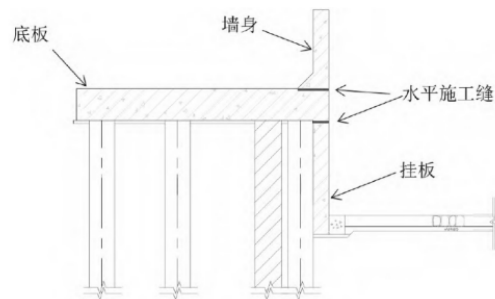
钢筋混凝土挡墙常规做法施工缝设置示意图
